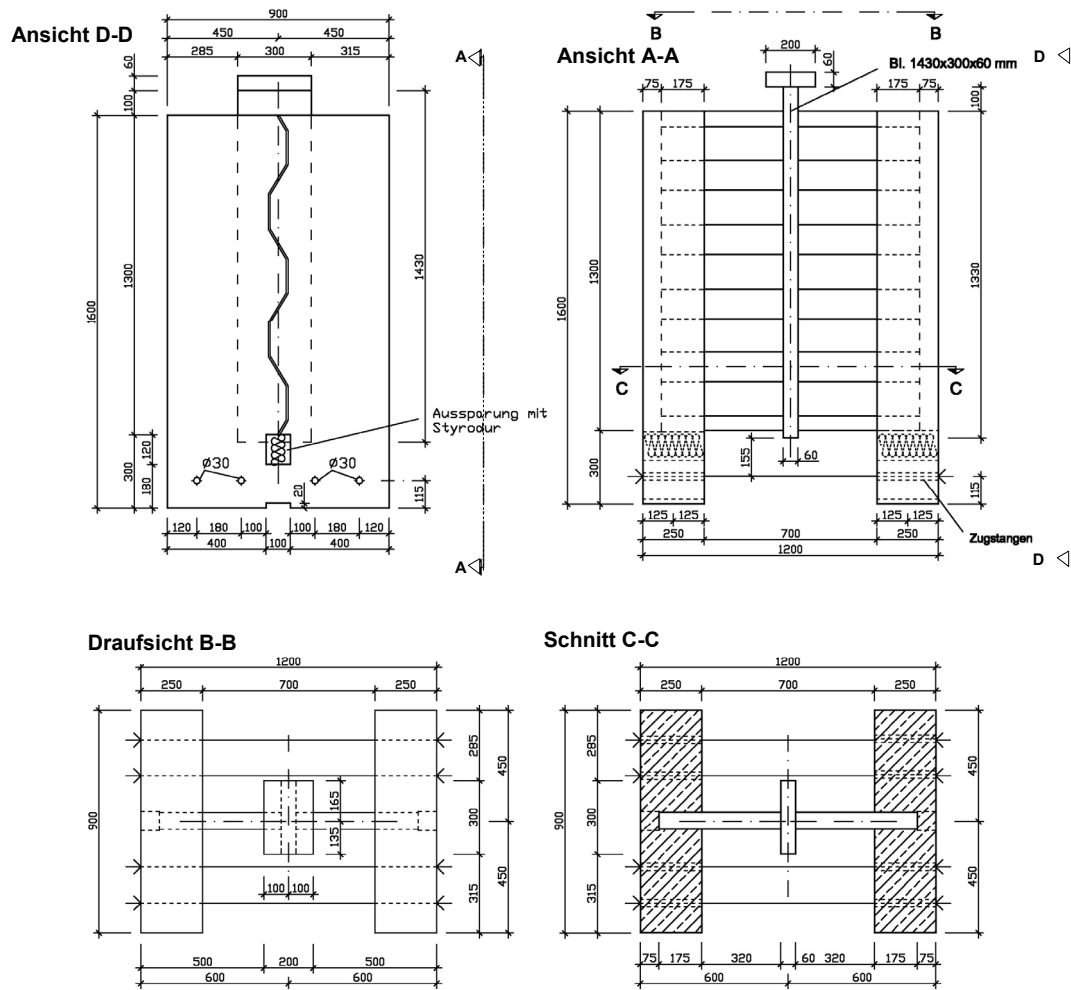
Schalplan der Push-out-Körper mit 175 mm Einbindung
